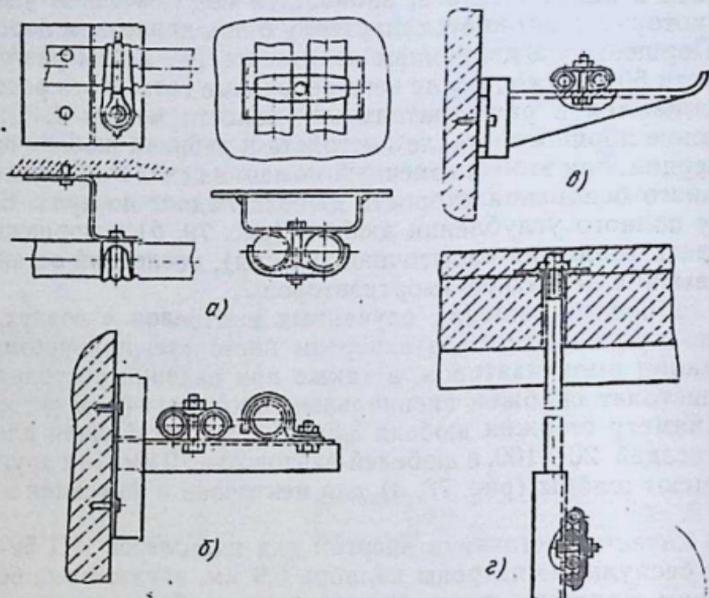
Прокладка одиночных трубных проводов на стойках — опорных скобах (а), опорных кронштейнах (б), кабельных полках (в) и подвесках (г)
